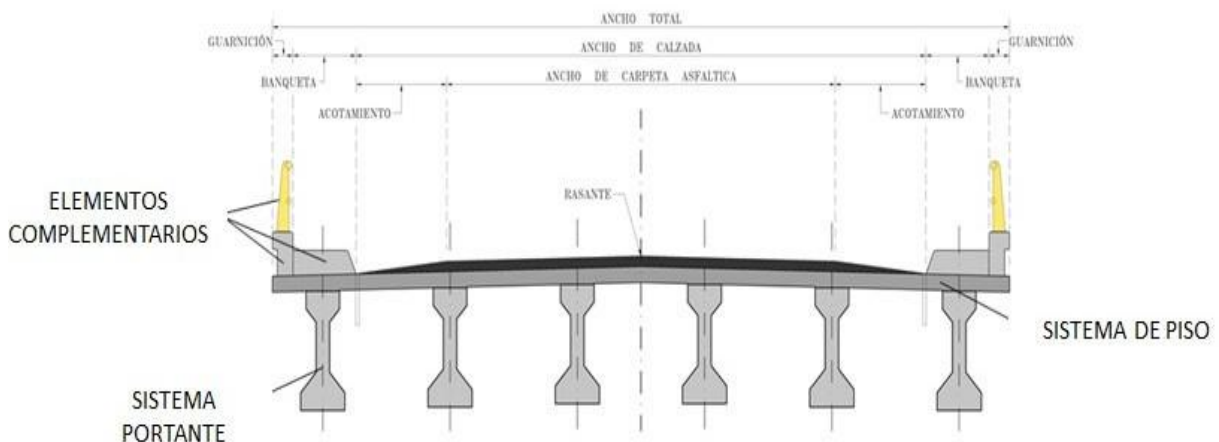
Elementos de la superestructura (Manual para Inspección de Puentes, 2018).
